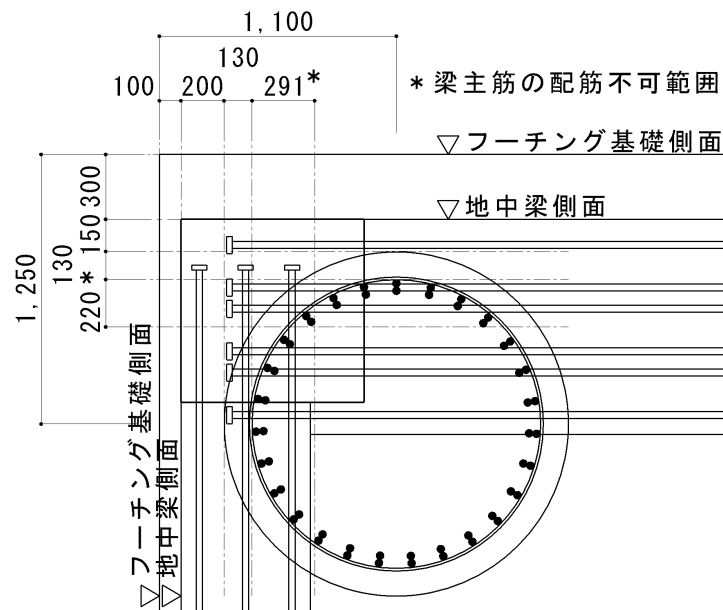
杭と基礎梁の配筋図(断面リスト通りの配筋を示す)
